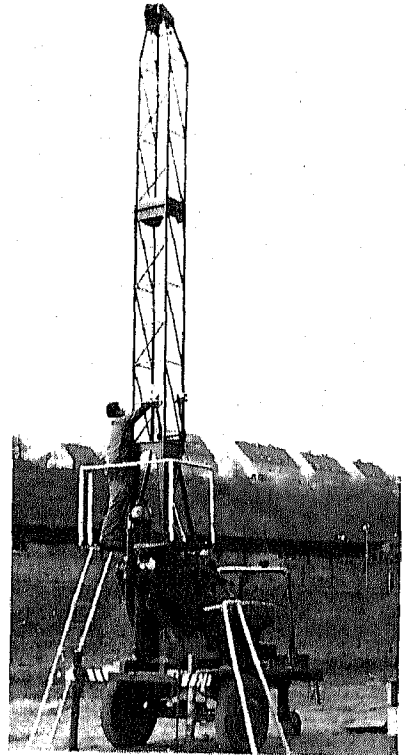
Spindeldrehbohrmaschine SG 750 der Salzgitter Maschinen AG
